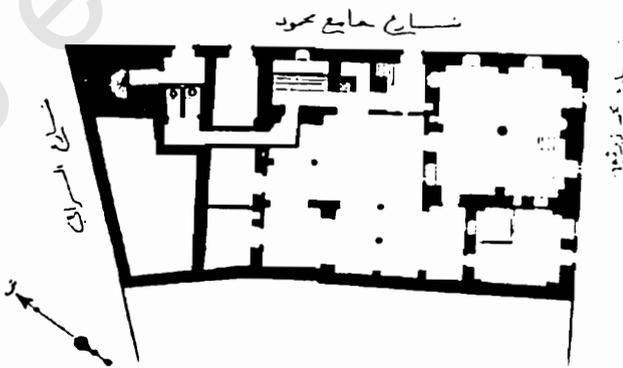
مسقط أفقي لجامع الشيخ عبد الوهاب عن الموسوعة (الجزء الأول).
